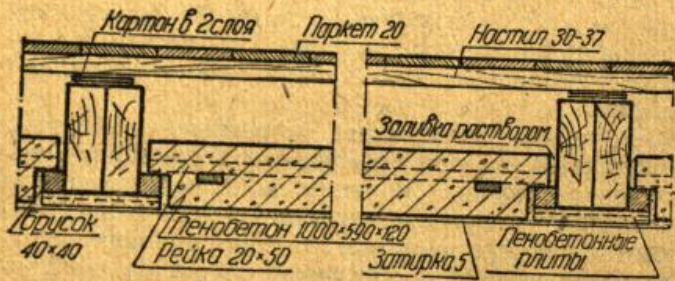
Междуетажное перекрытие Техпроекта с накатом из пенобетонных блоков.
